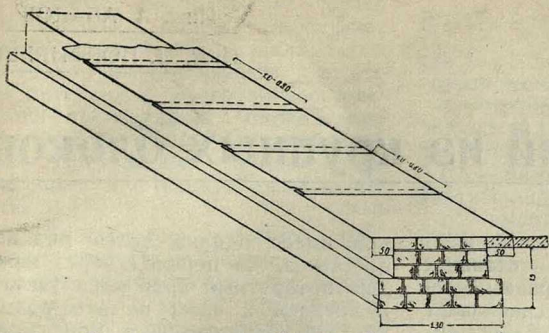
Схема поперечной наклейки руберойда по горизонтальной плоскости фундамента
